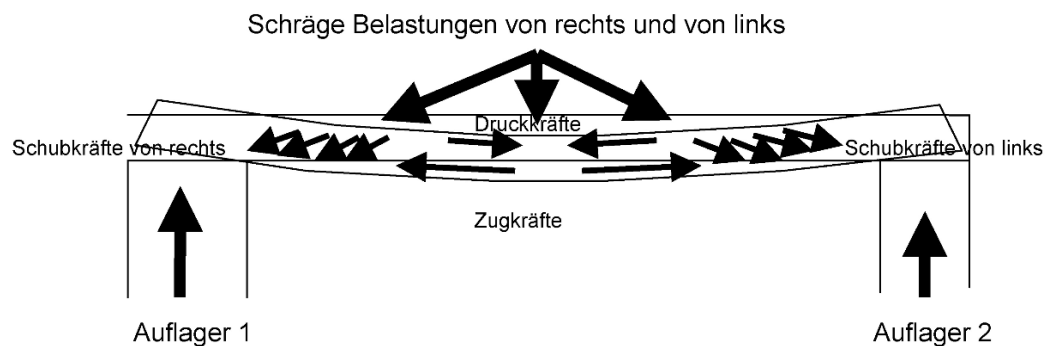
Kräfteschema an einer Decke oder einem Überbau
